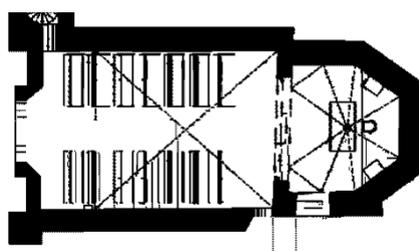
Planta arquitectónica de la Parroquia. (Esquivel, V. 2017)
